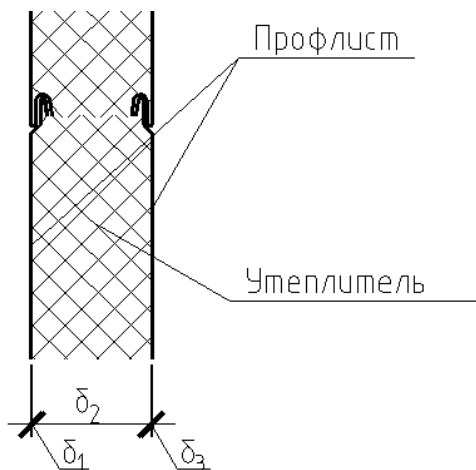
Расчетная схема стеновой ограждающей конструкции
